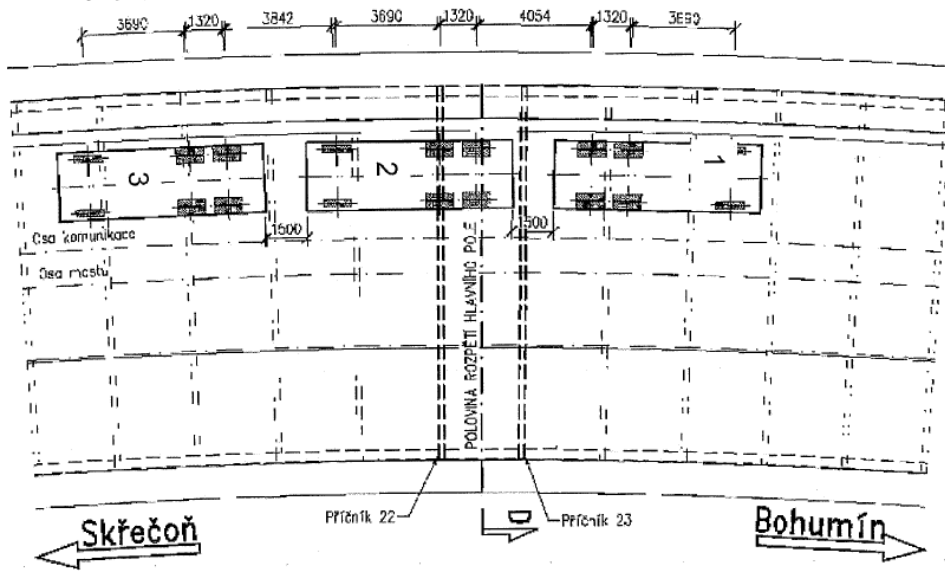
Schéma zatěžovacího stavu ZS1- půdorys [6]
